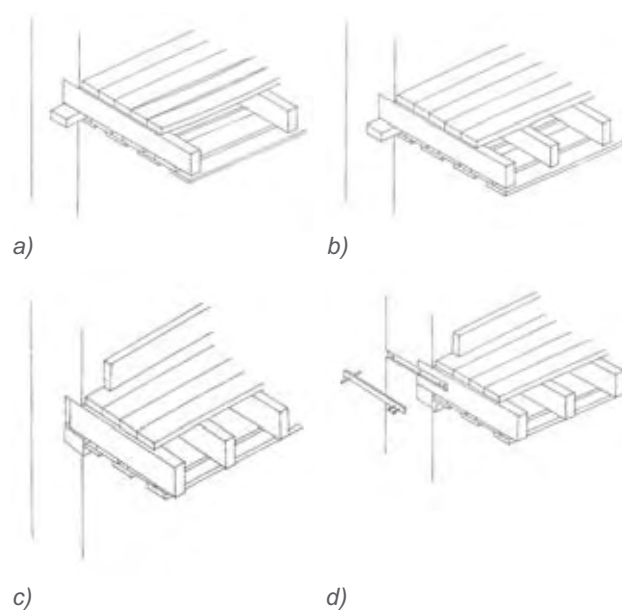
a), b) adição de novas vigas paralelas às vigas do pavimento;
